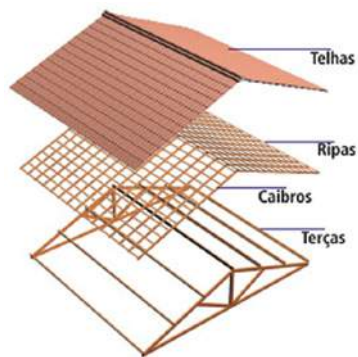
Elementos de um telhado. Fonte: <<http://www.fazfacil.com.br/reforma-construcao/madeiramento-do-telhado/>>.
